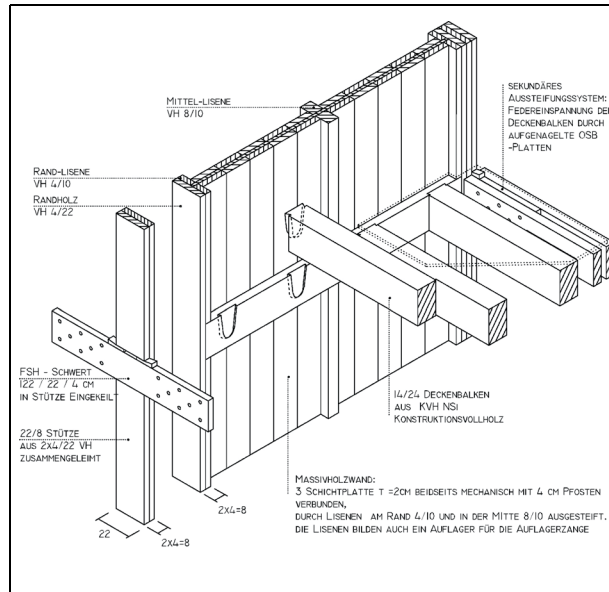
Montage Rohbau Knoten Wand – Decke mit Skelettstütze
